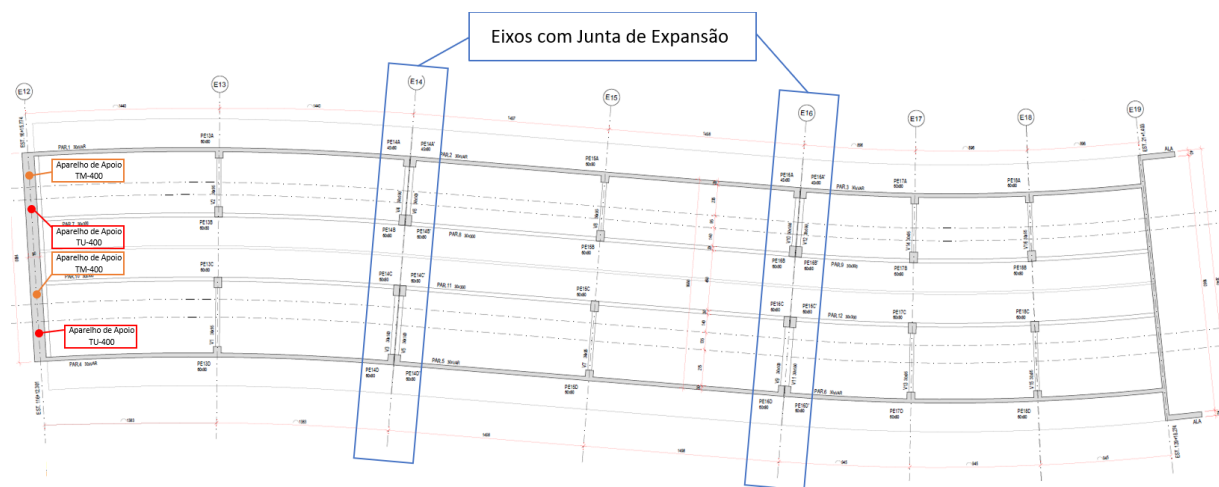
PLANTA ENCONTRO ESTRUTURADO (EIXOS E12 A E19)
